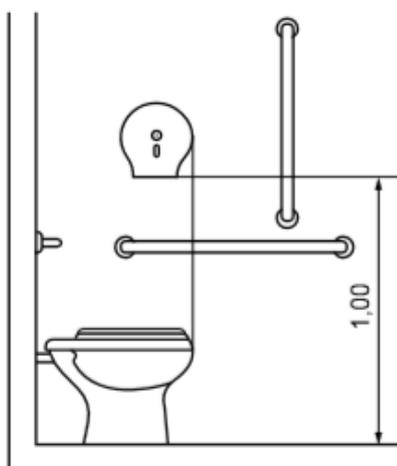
Localização da papeleira de sobrepor (rolo) – Vista lateral
